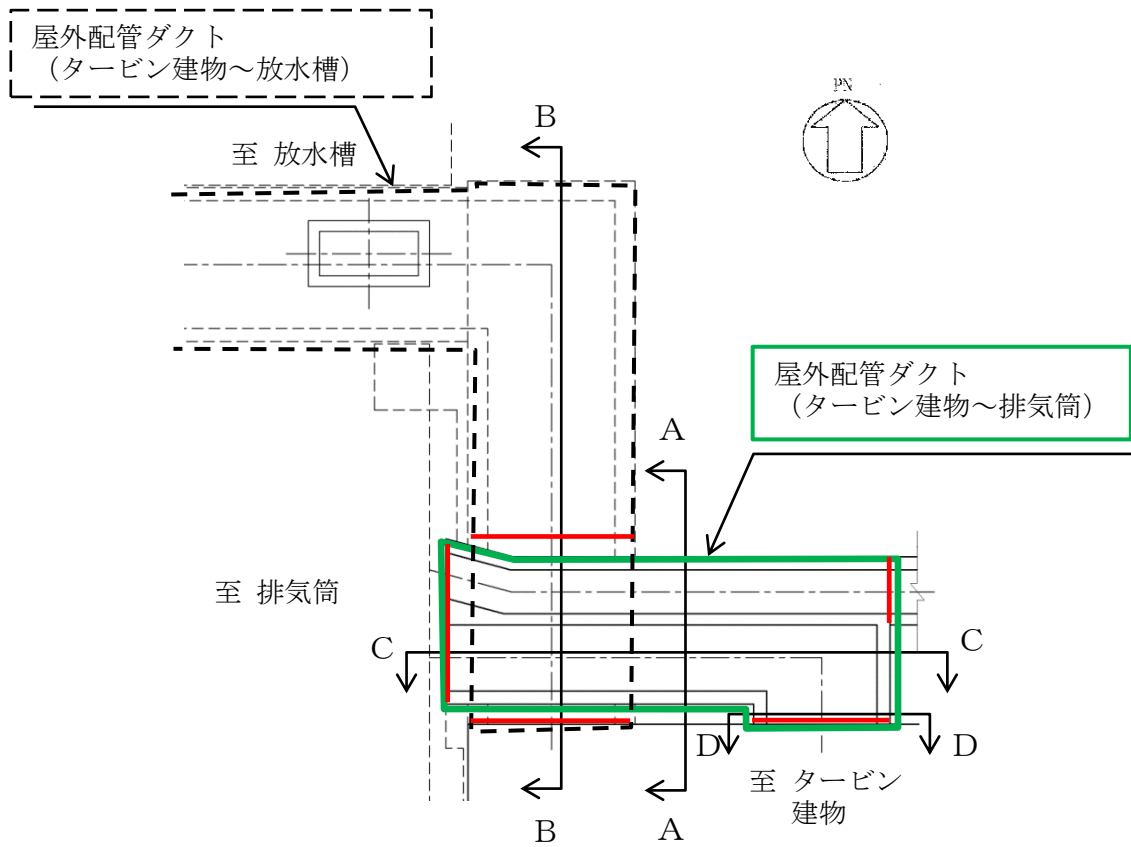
屋外配管ダクト (タービン建物～排気筒) 平面図
